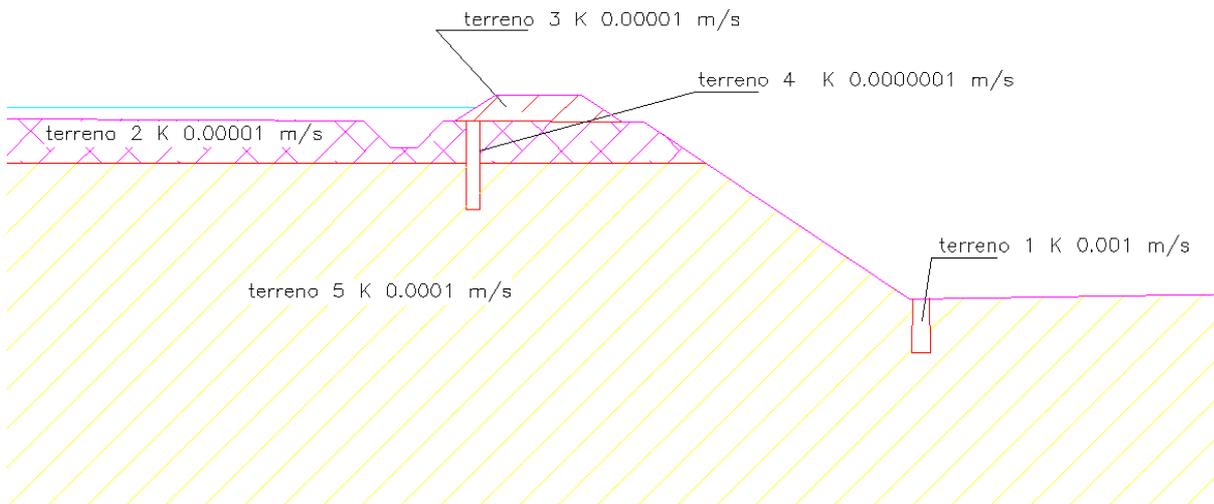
schema di verifica alla filtrazione del rilevato a protezione delle trincee
